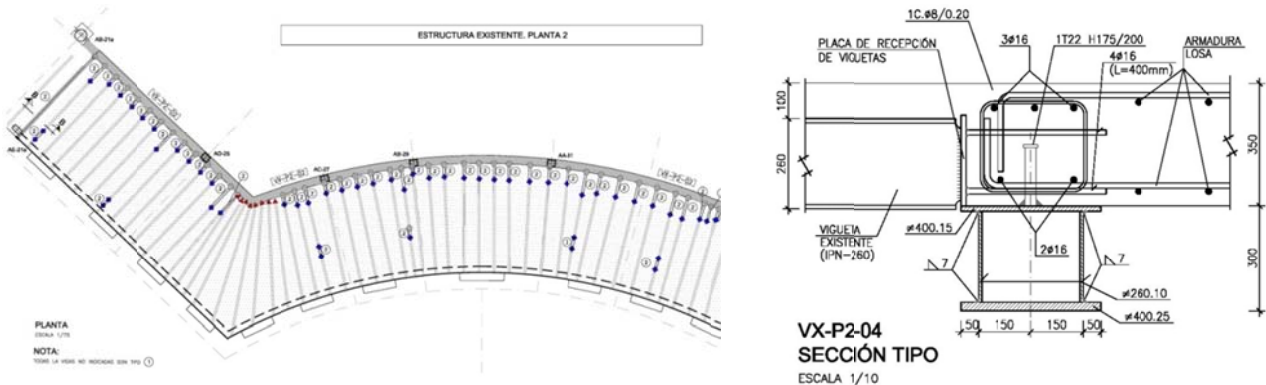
Planta de forjado original en el edificio de Canalejas 1 (izquierda) y sección transversal de la viga de transición entre la primera crujía y la estructura interior
